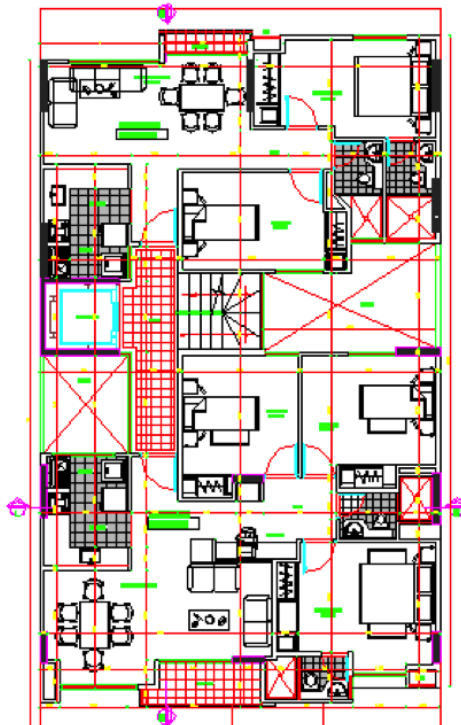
Planta pisos 6 y 7, apartamento tipo 1 y penthouse.
